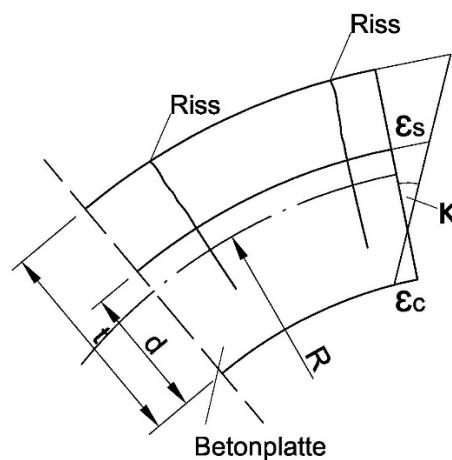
Dehnungen im biegebeanspruchten Betonkörper
